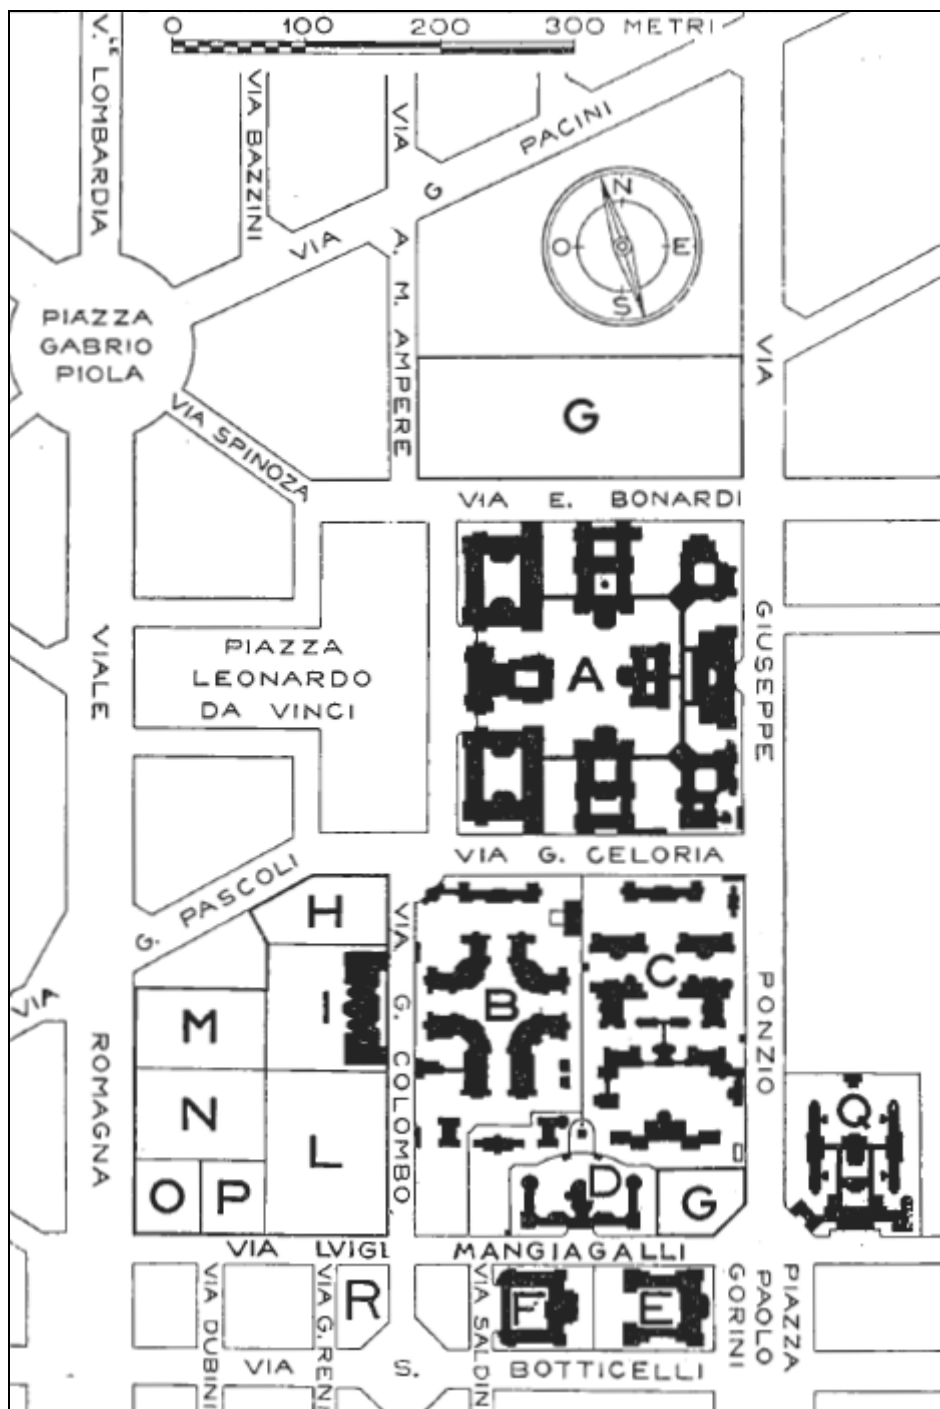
Planimetria della "Città degli studi" nel 1927
